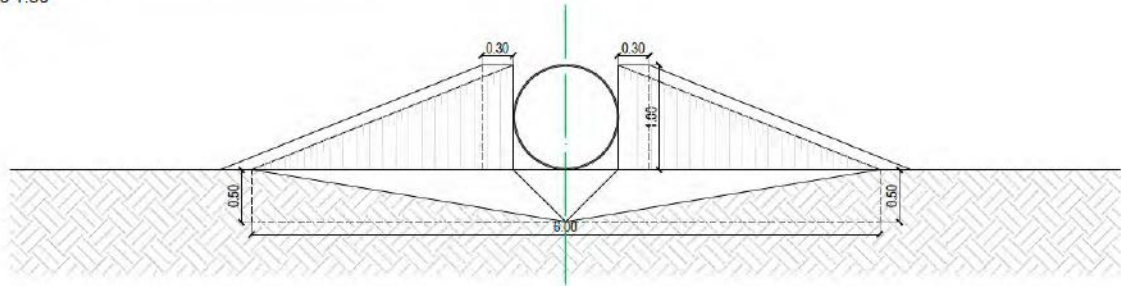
Detalle de desembocadura en calle Canal. Reservorio R01.
